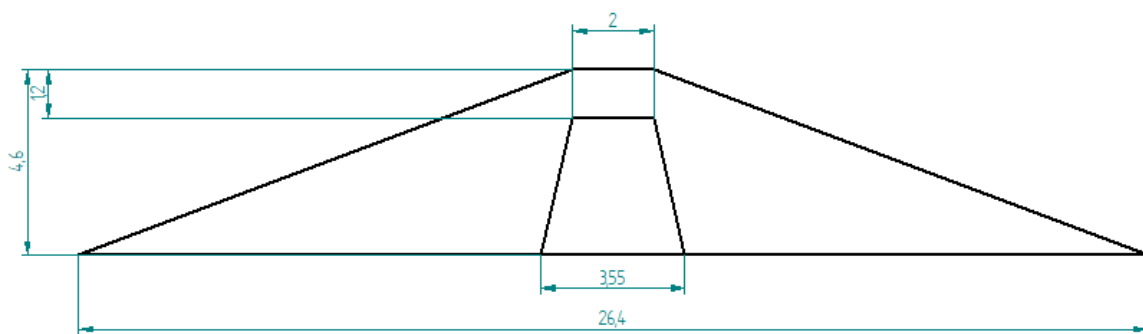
Sección de la estructura ISO (m). Fuente propia
